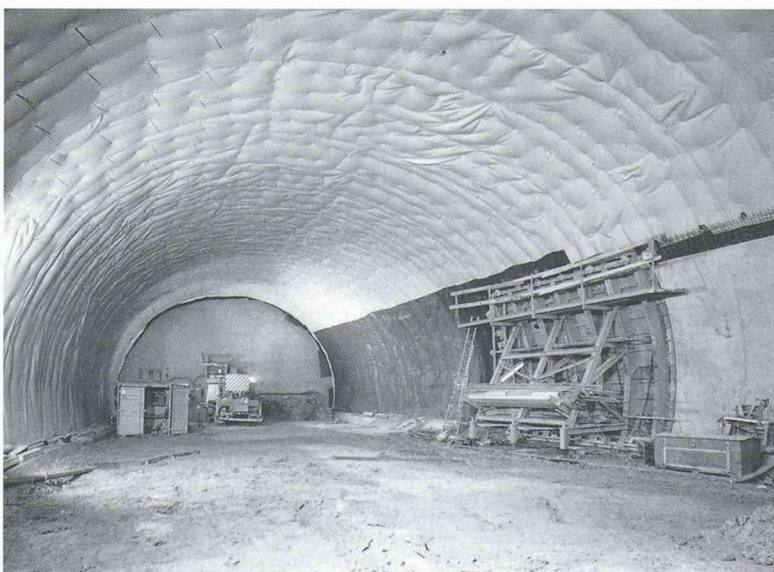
Gare de Chauderon: étanchéité en PVC avec ancrages pour la suspension du treillis d'armature du revêtement intérieur, protection par une couche de PVC recyclé sur les piédroits, coffrage pour le bétonnage de ces derniers
